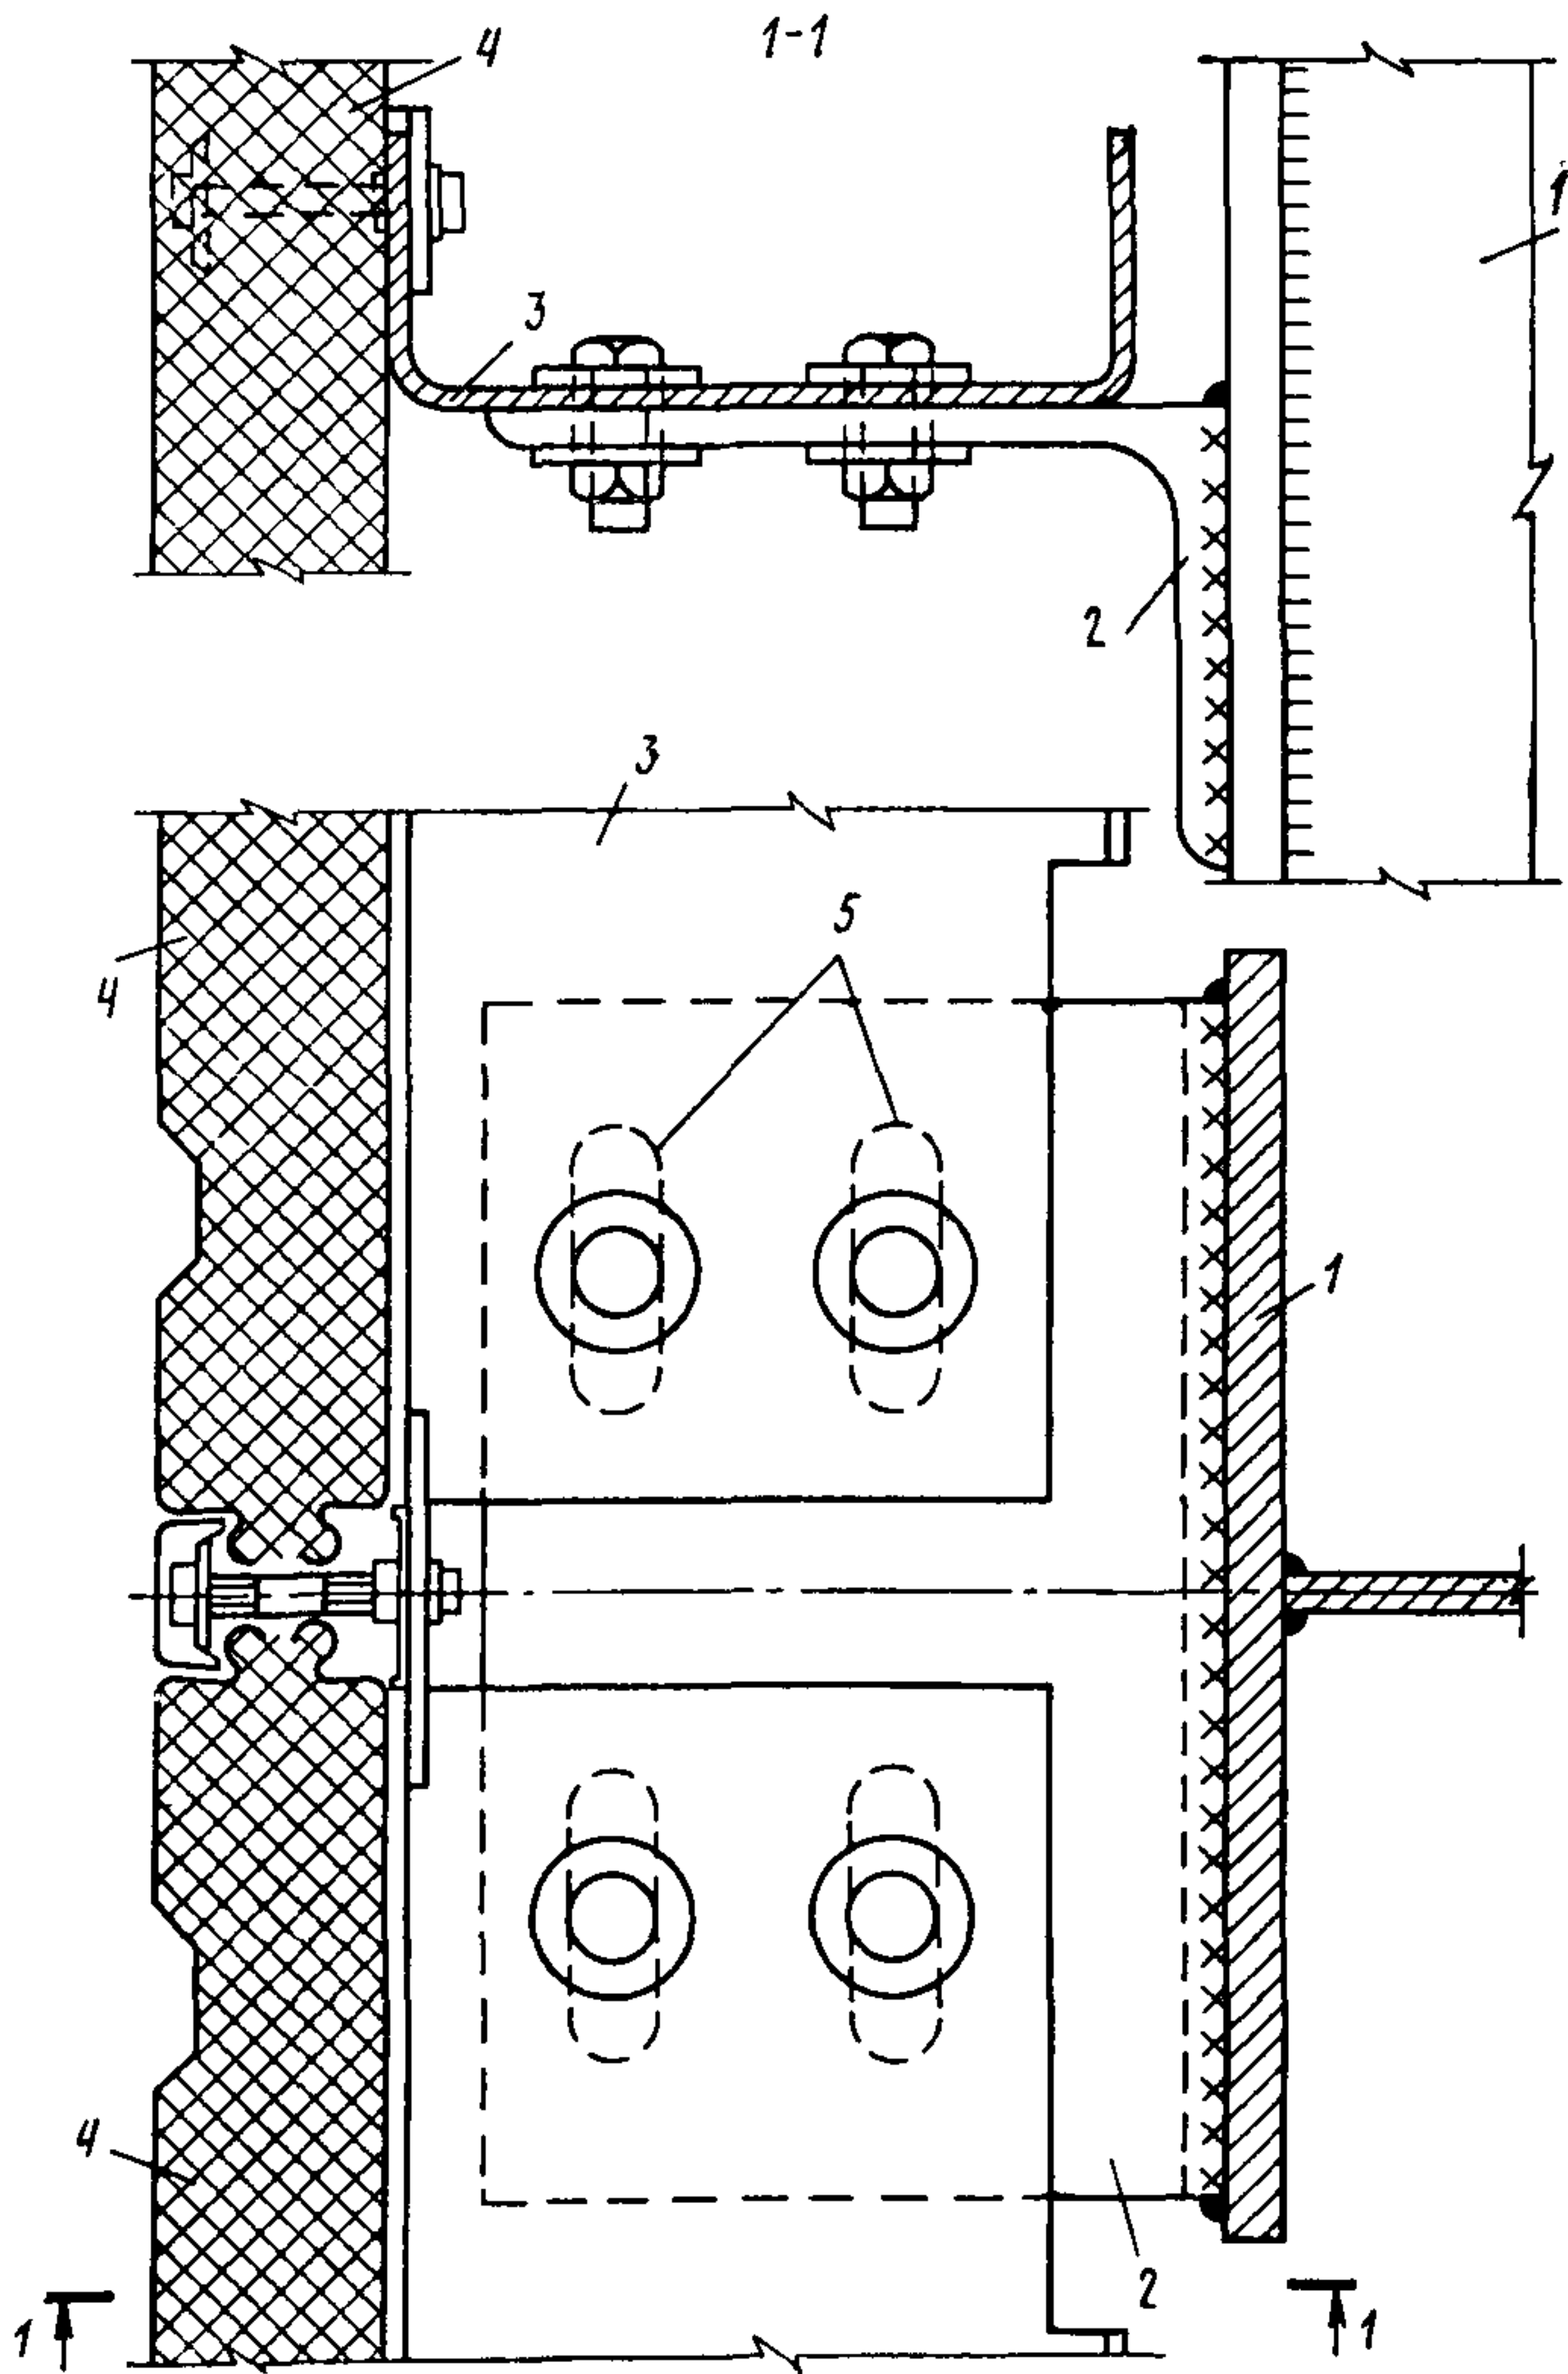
Пример крепления металлической стены из трехслойных панелей к колонне в уровне рядовых ригелей стены
